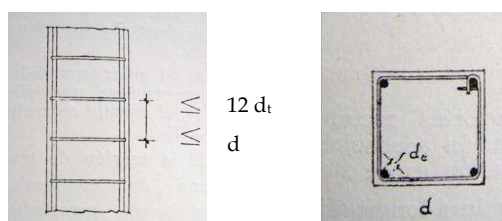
Disposiciones de la armadura transversal en pilars.
